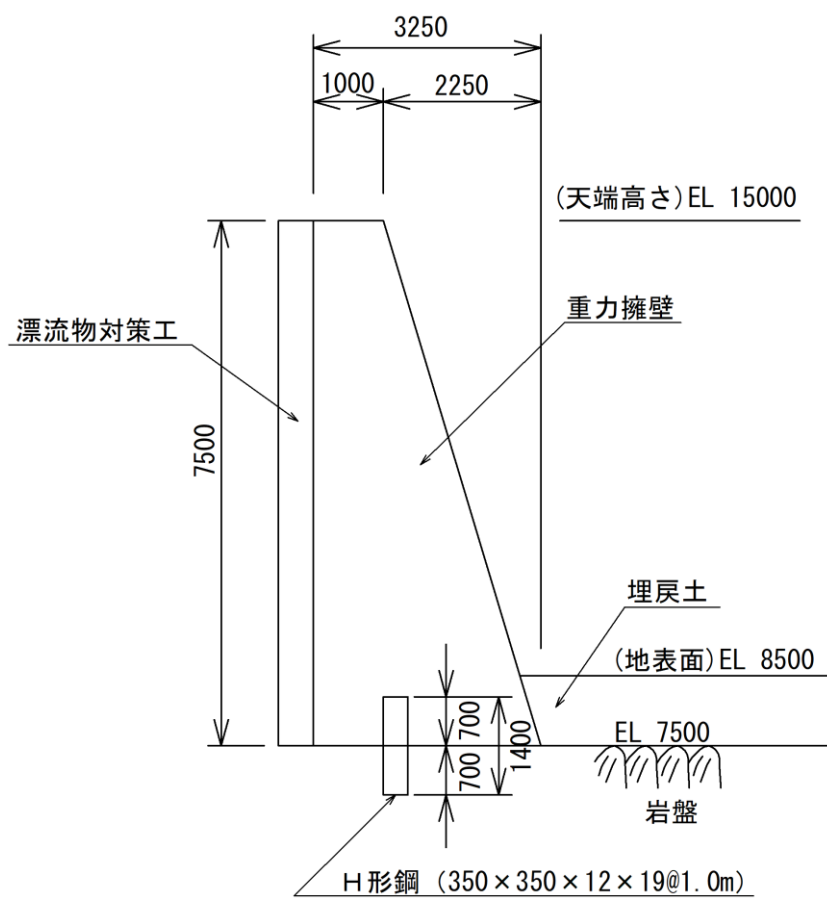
(9) 防波壁 (波返重力擁壁) の構造図 (断面図) (⑤-⑤断面)
